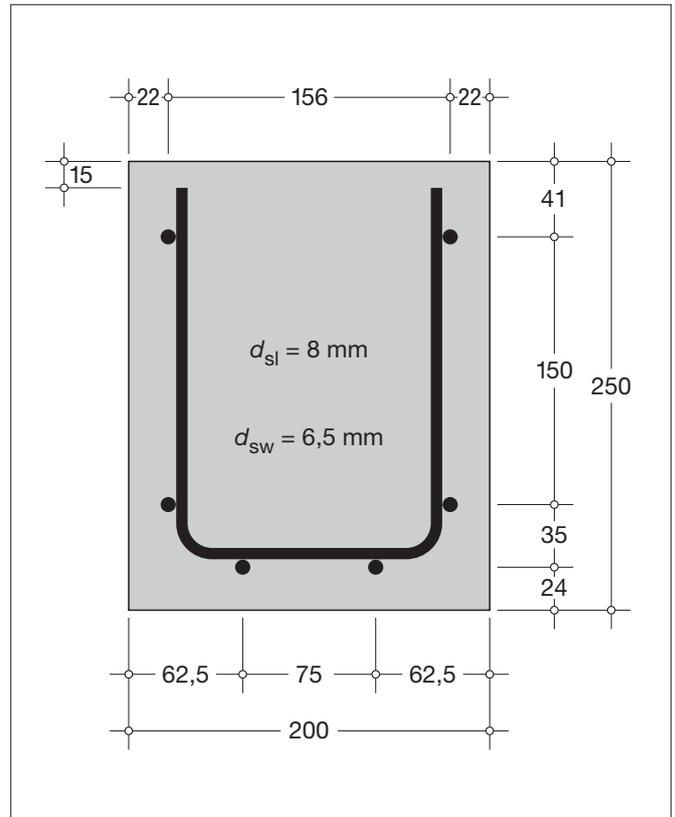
Balkenquerschnitt mit Querkraftbewehrung; Abmessungen
